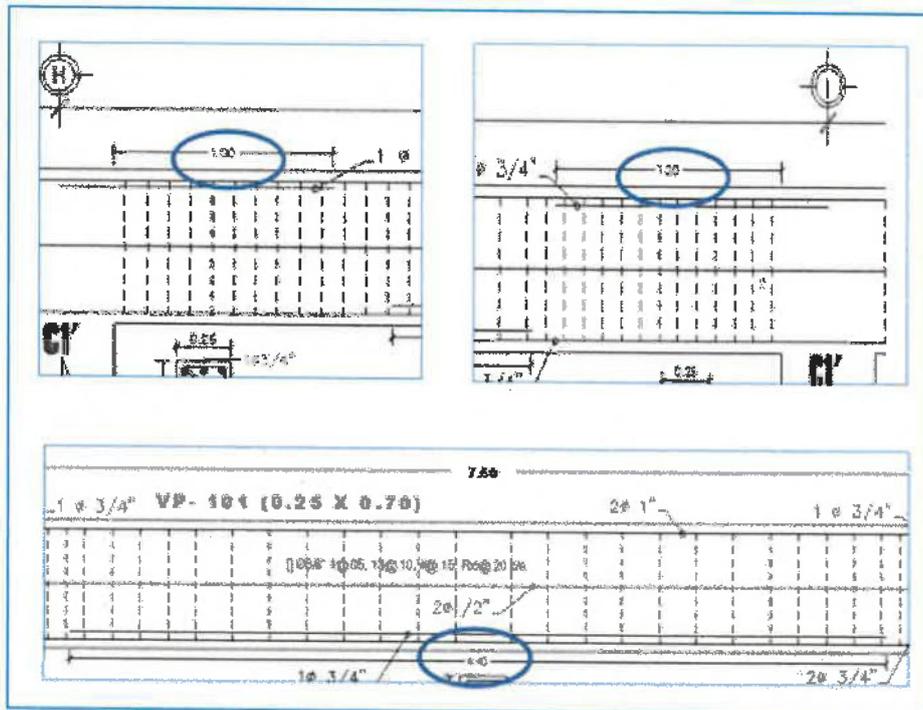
Detalle de acero de refuerzo en viga, según expediente.
